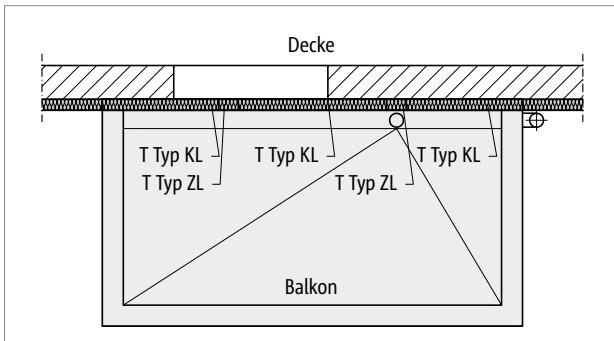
Schöck Isokorb® T Typ ZL, KL: Aussparung für Entwässerung mit Schöck Isokorb® T Typ ZL
